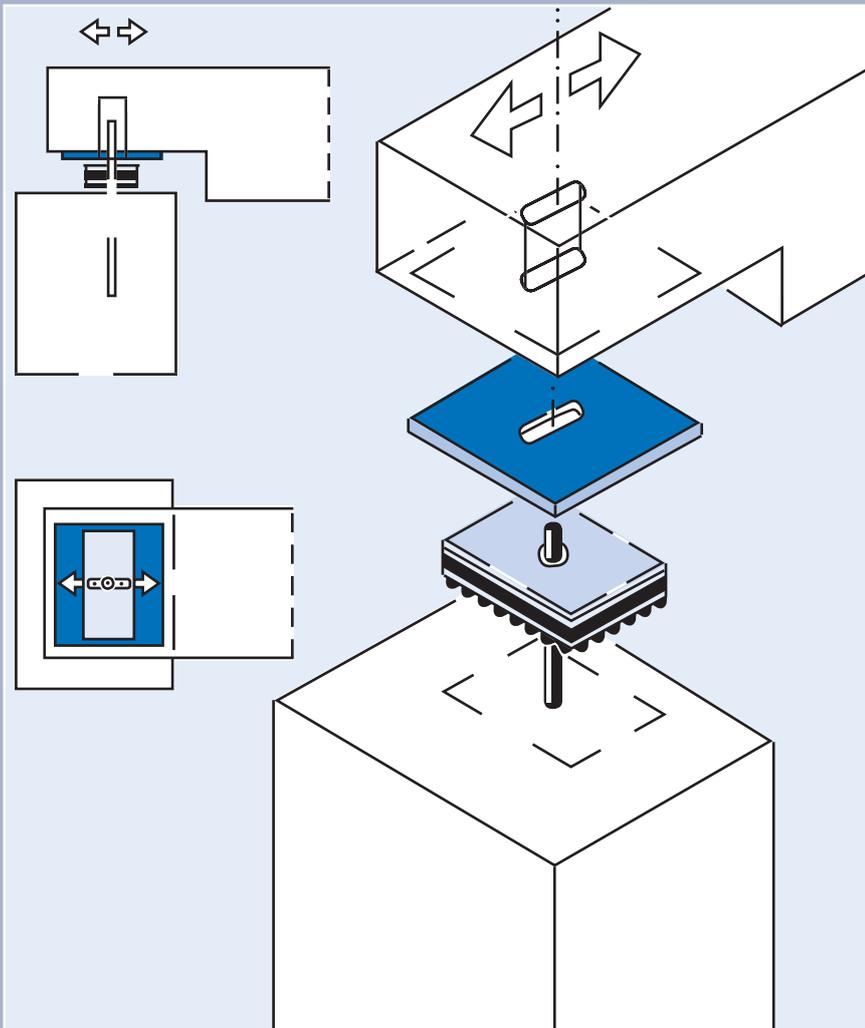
Einbau eines Ciparall®-Gleitlagers mit Bohrung und Langloch
